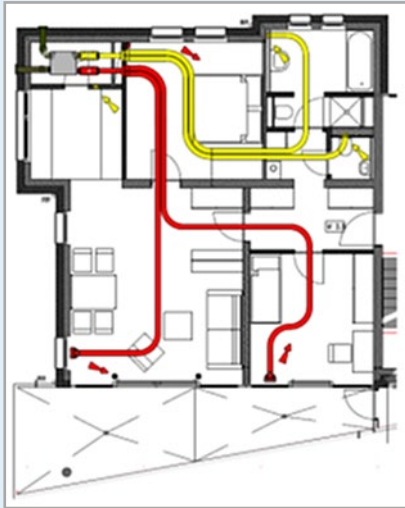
Darstellung des Lüftungskonzepts im Grundriss
